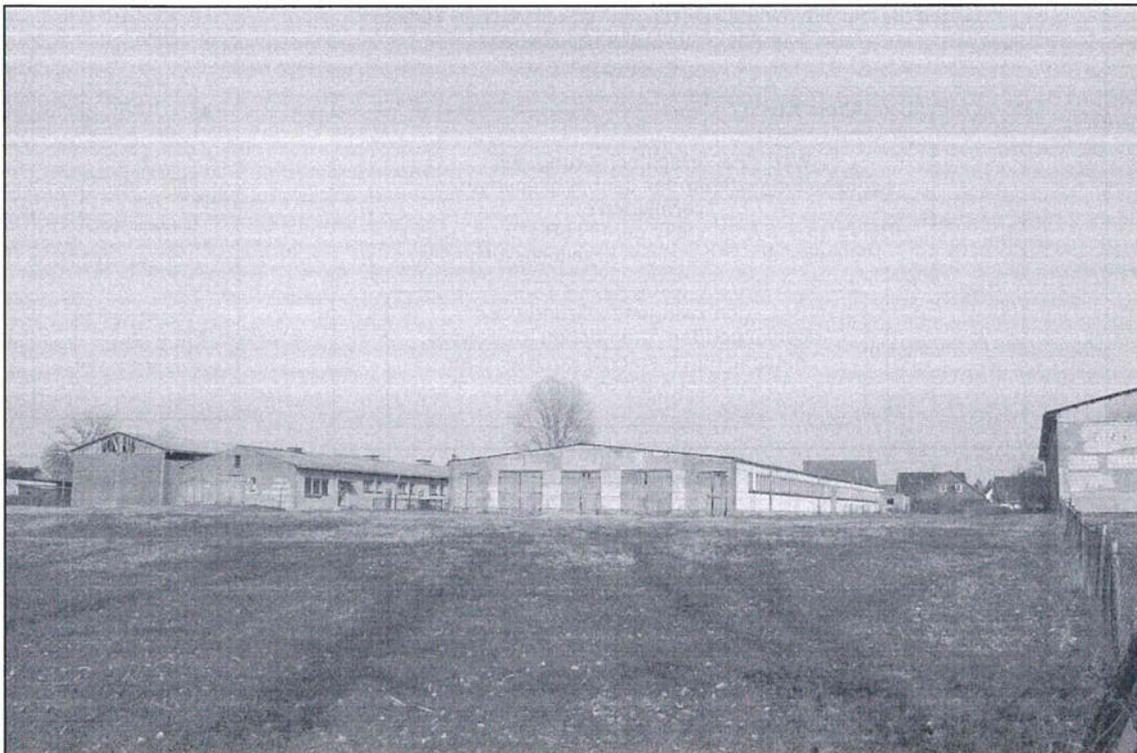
Vorhandene Bebauung mit einer halboffenen Scheune, zwei Stallanlagen und einer Lagerhalle (v. l.), 24.03.2015.
